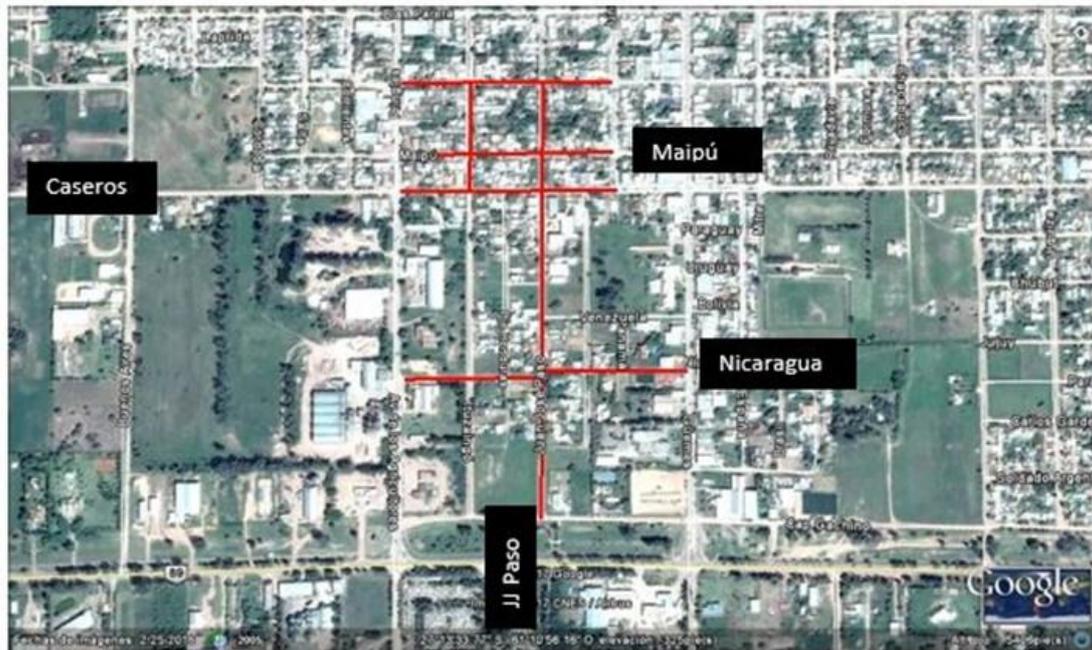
Proyecto de pavimento dentro de ejido de la localidad de Charata
